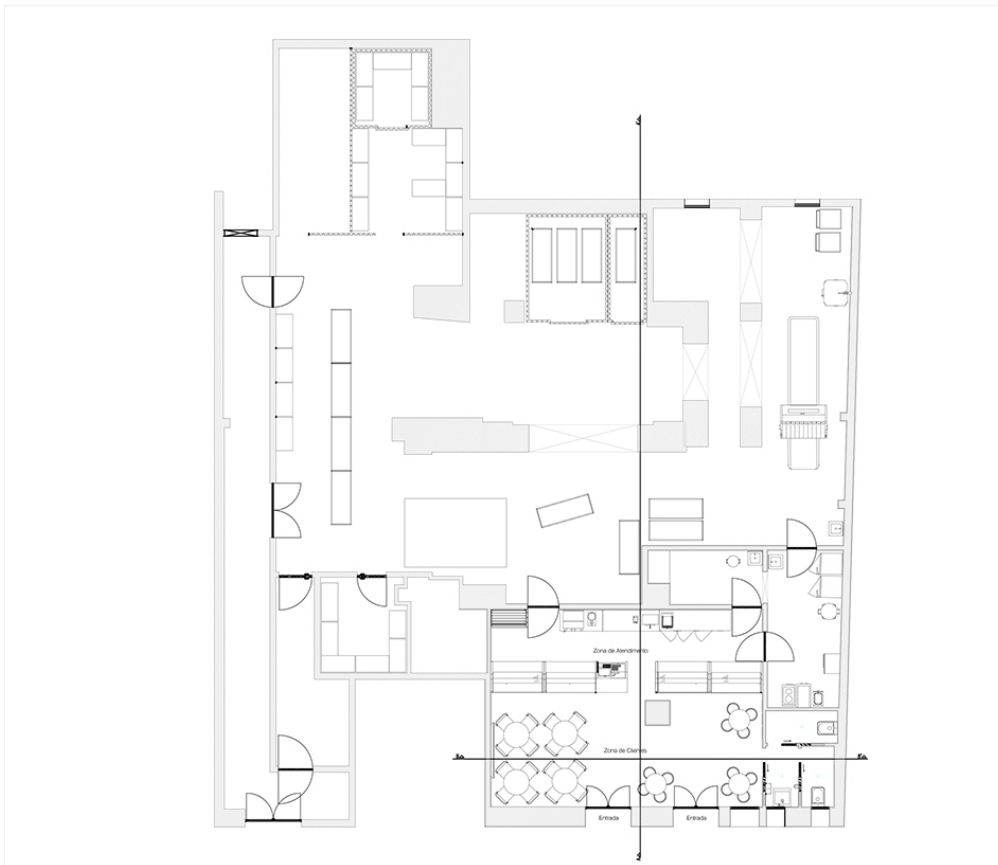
Planta geral da padaria, área de venda e zona de produção
